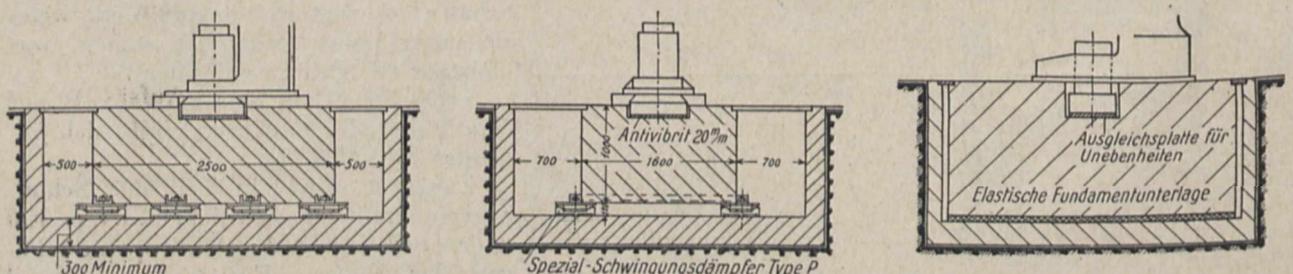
Hammerfundamente mit Isolierung gegen Schall.
